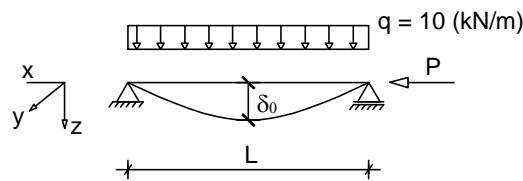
Exemplo de aplicação de viga-coluna.
